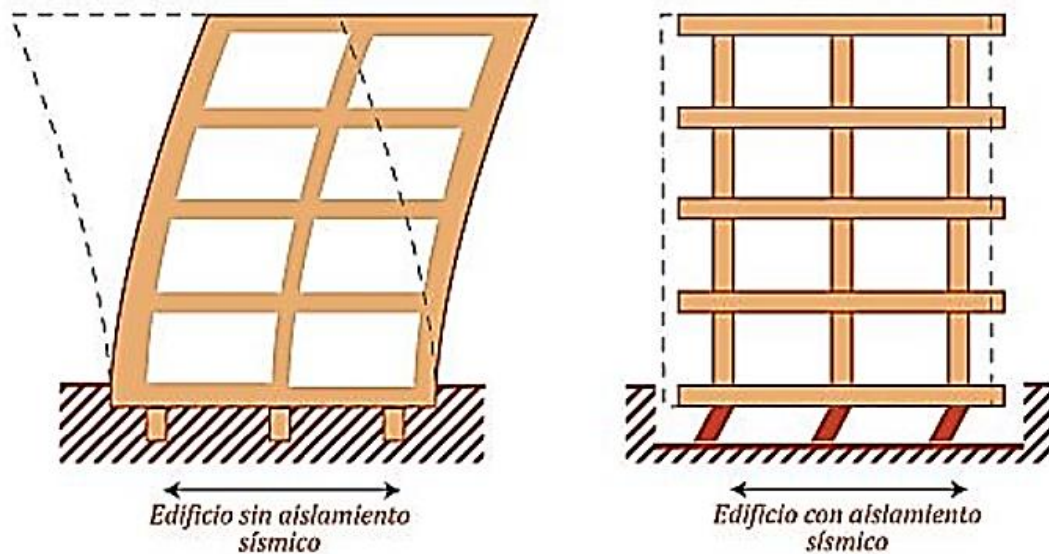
Edificación sin aislamiento sísmico y edificación con aislamiento sísmico
